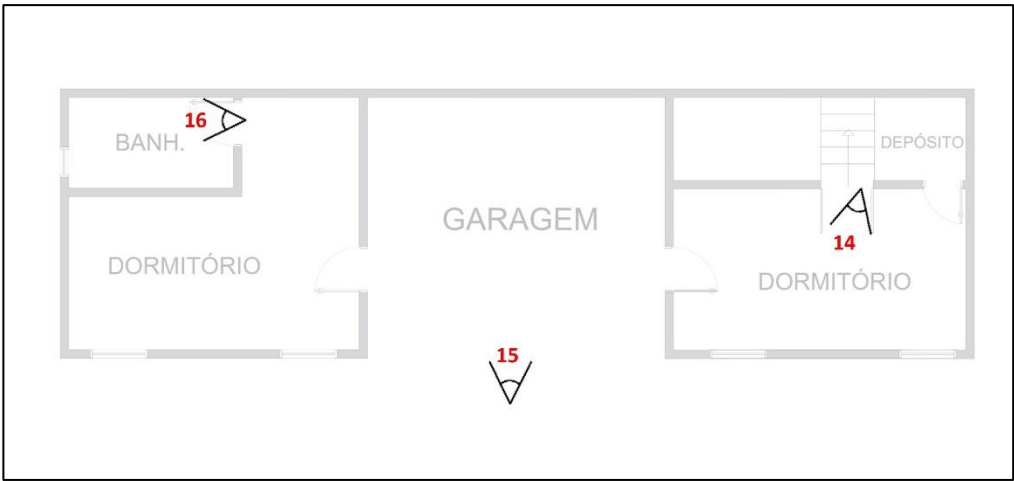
Croqui do imóvel avaliando: pavimento térreo (Fonte: o Autor)
